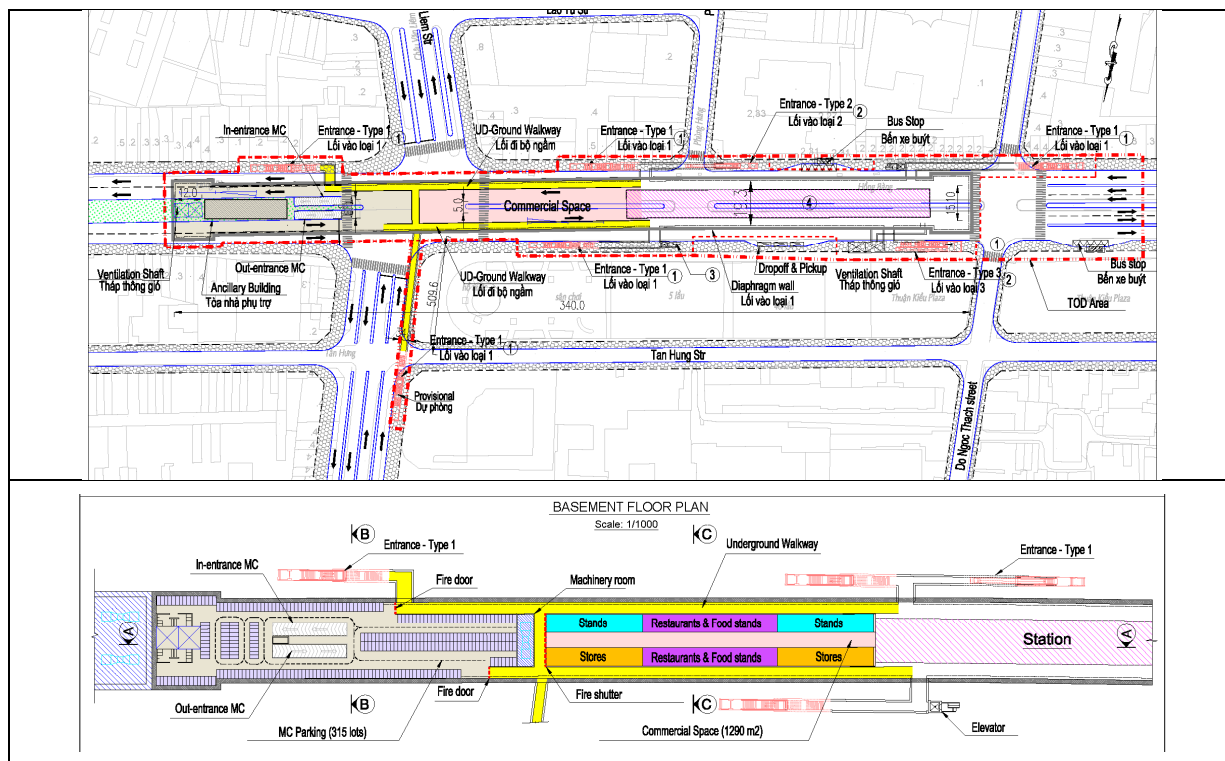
C5 タンキエウ駅地下駐輪場・商業施設整備図(配置図・平面図)
